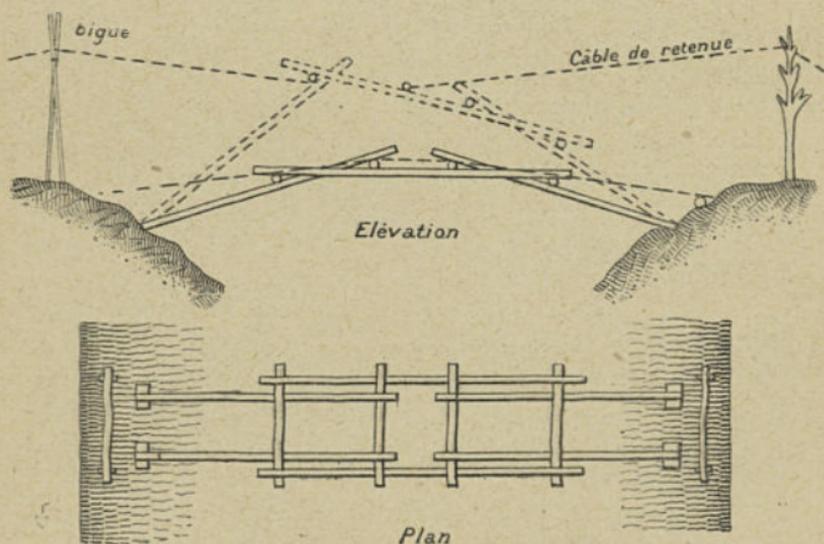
Passerelles sur poutrelles arc-boutées.
